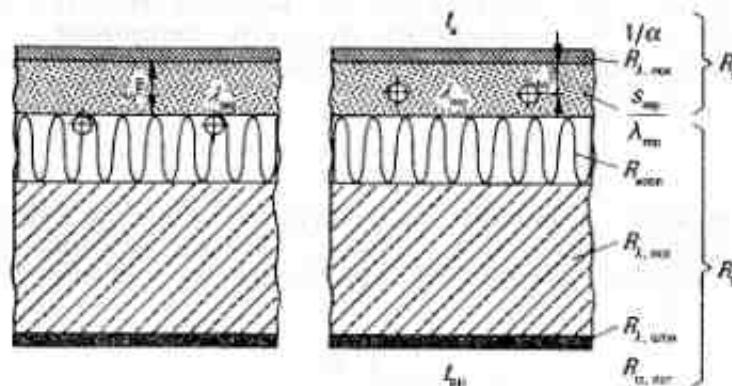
Схематическое изображение конструкции потолочного перекрытия с системой напольного отопления:
